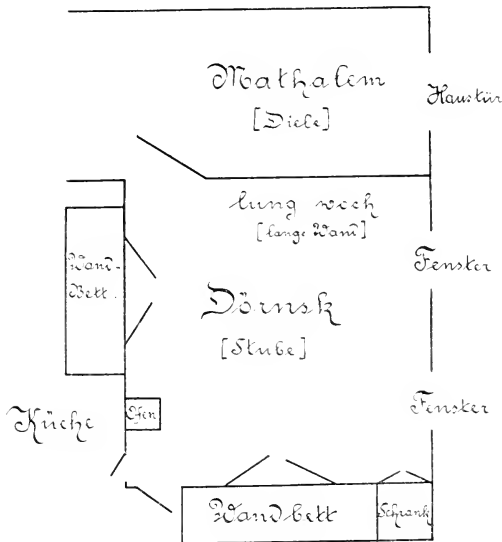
Grundriss der Stube des Föhrer Hauses.
